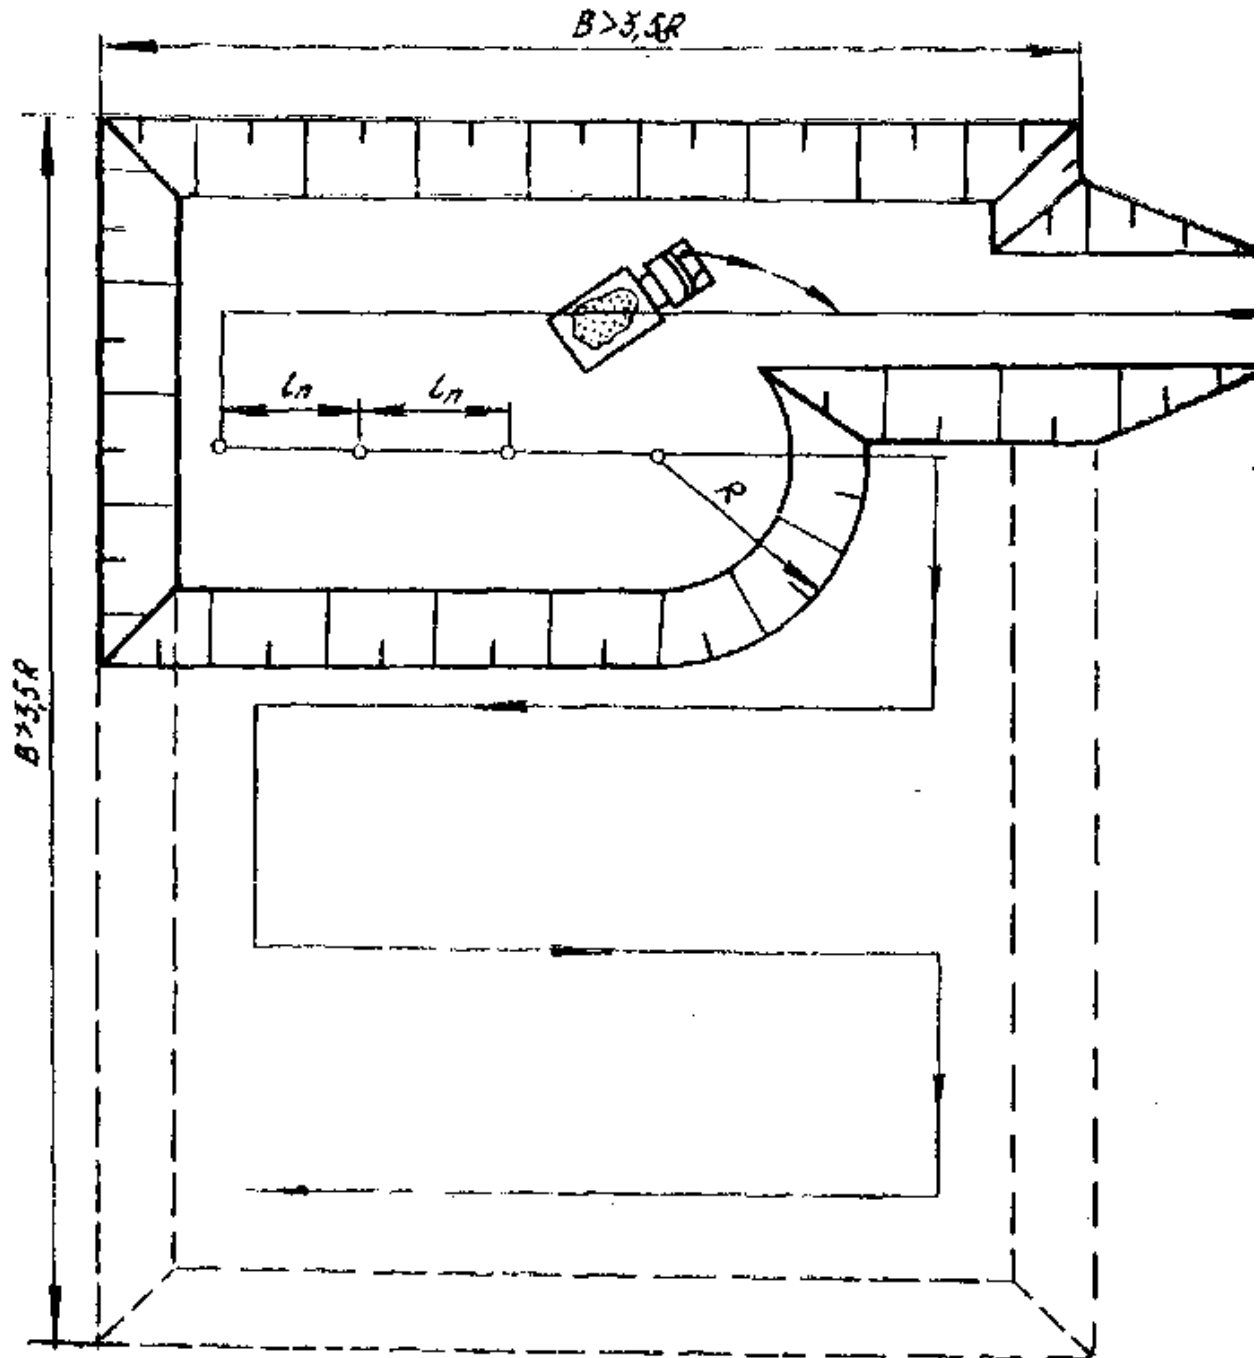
Схема разработки котлована боковой проходкой экскаватором, оборудованным прямой лопатой.
